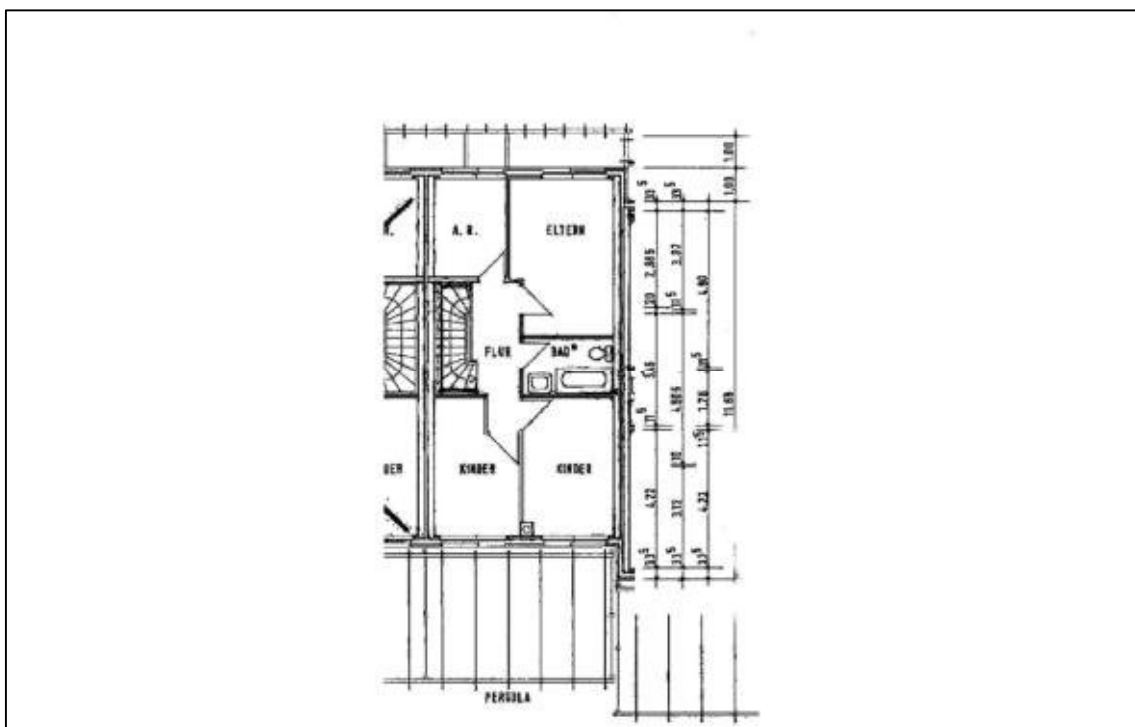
Grundriss vom Obergeschoss
